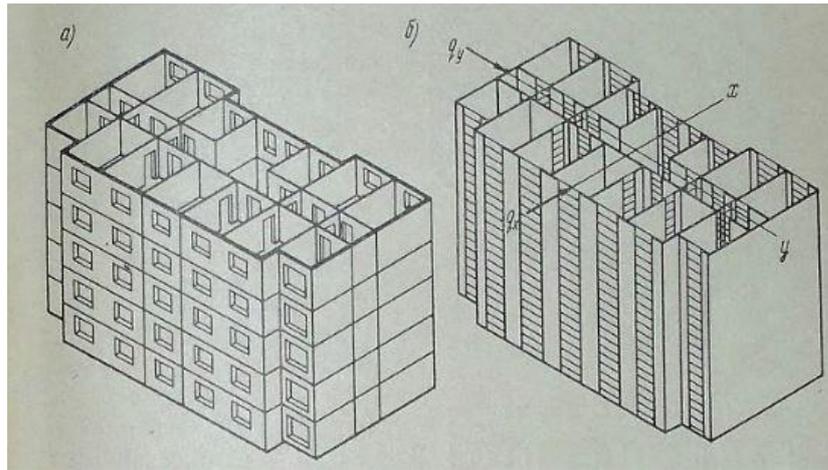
Расчетная схема в виде перекрестной системы
